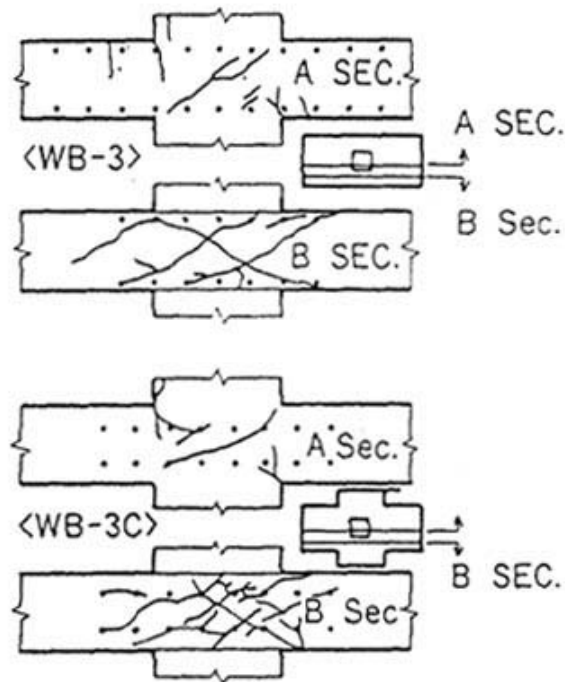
Patrón de grietas internas en una junta de viga plana-columna, tomada de Hatamoto et. al. [3]
